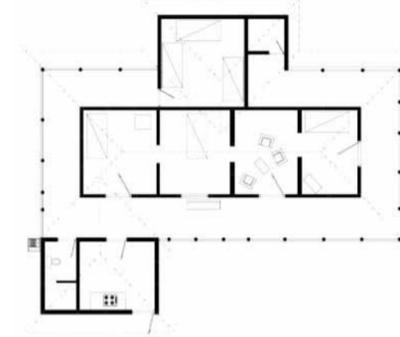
Fuente: Autor. Planta levantamiento arquitectónico vivienda cafetera tradicional. Tipología "L".
